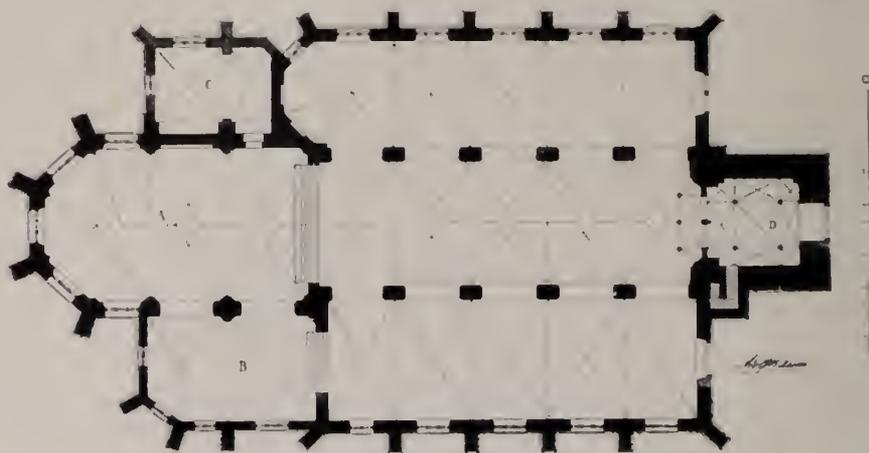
Sonsbeck. Grundriss der kath. Pfarrkirche.
